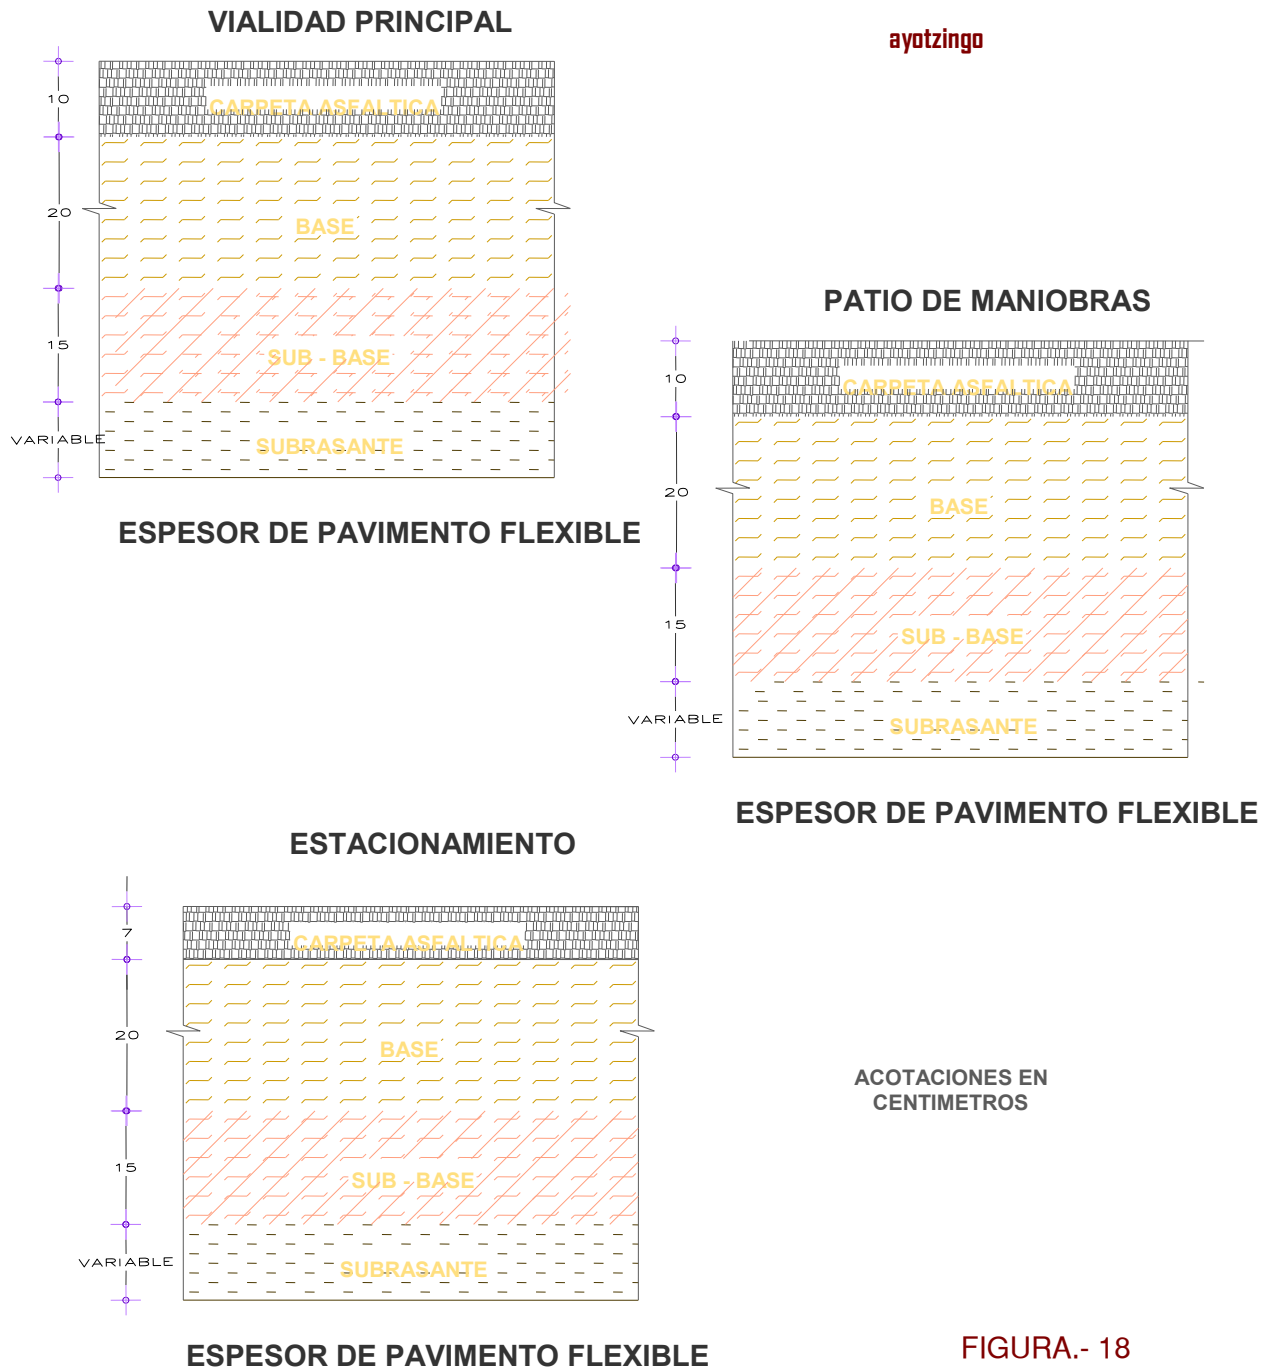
SECCIÓN ESTRUCTURAL DE PAVIMENTOS FLEXIBLES
